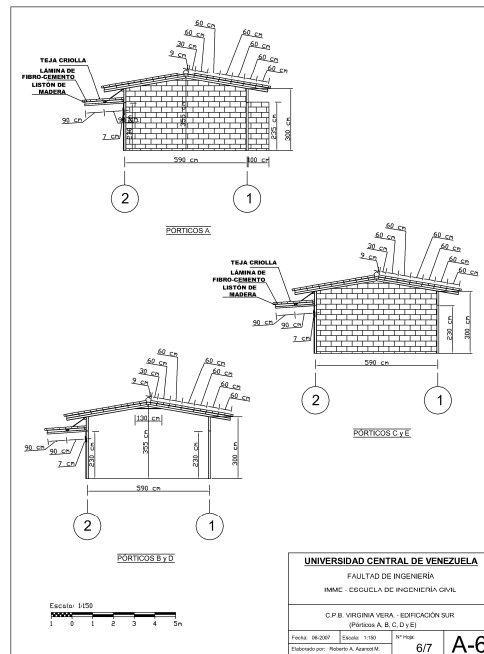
Plano A6: Plano Arquitectónico de los pórticos A, B, C, D y E
